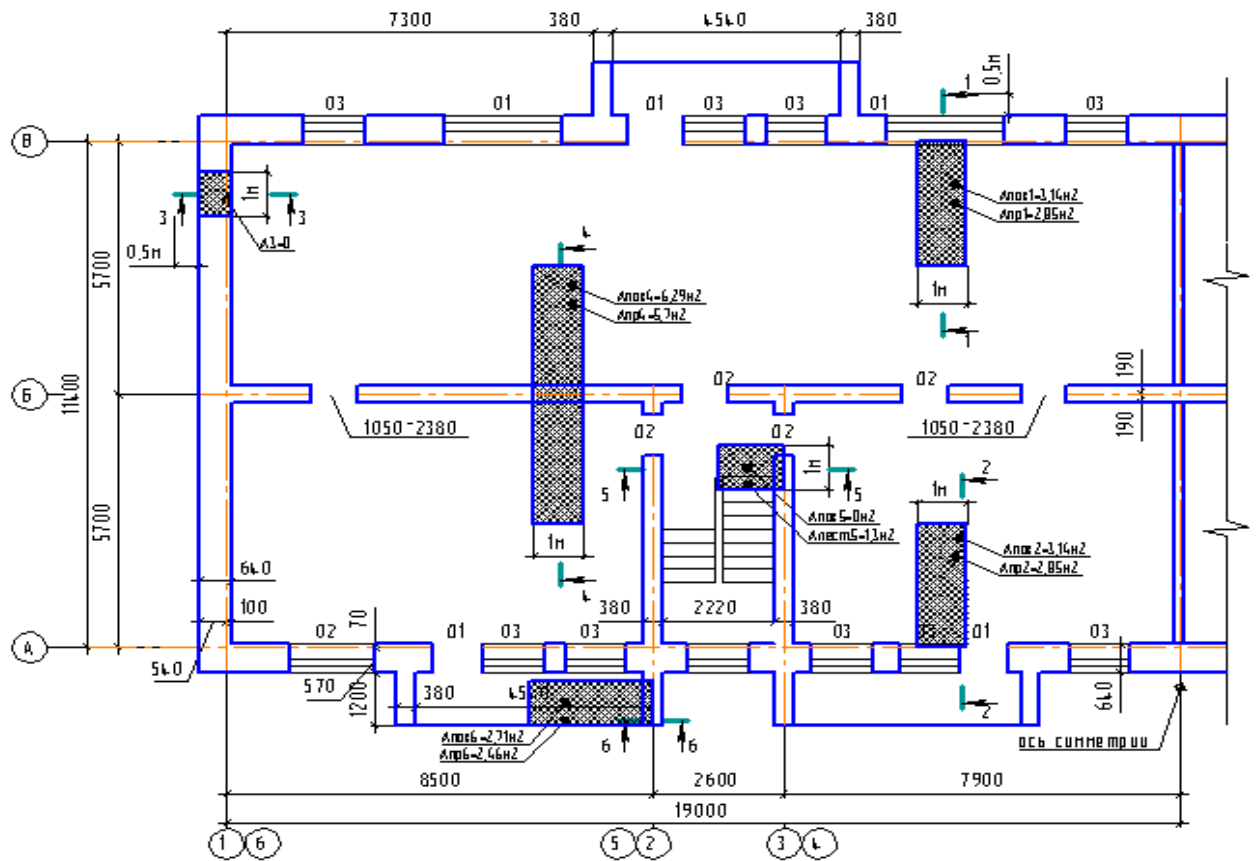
Расположение расчётных сечений на плане (площади покрытия).
